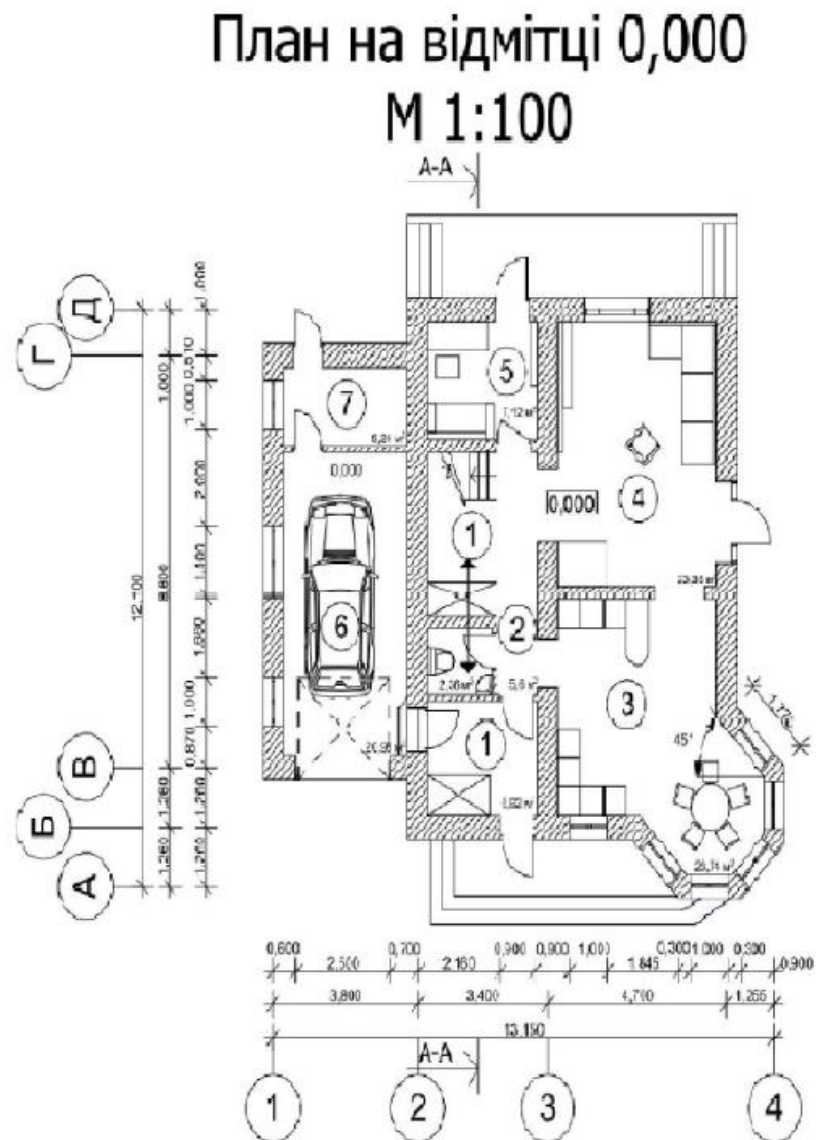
Індивідуальний 6-и кімнатний двоповерховий мансардний житловий будинок з гаражем. План 1-го поверху: 1 – тамбур; 2 – хол; 3 –кухня; 4 – вітальня; 5 –кабінет; 6 – гараж; 7 – котельня;
